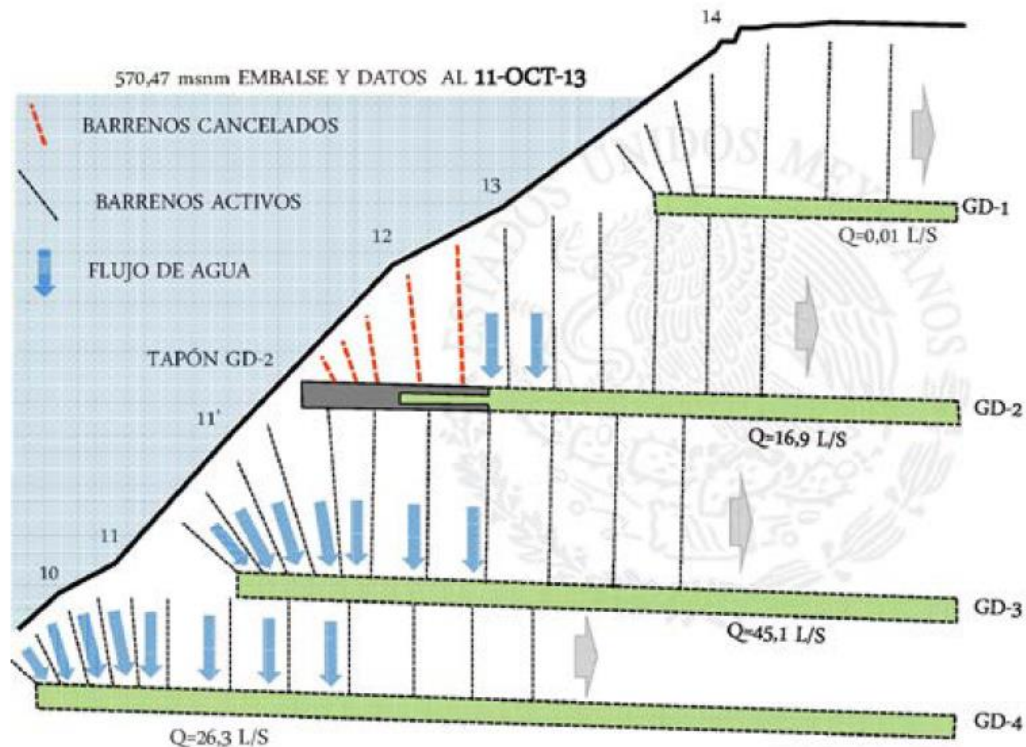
Esquema de la interacción de las galerías y barrenos de drenaje en el sector oriente, próximos al plinto (sección por la pantalla de impermeabilización) (CFE,2013).
